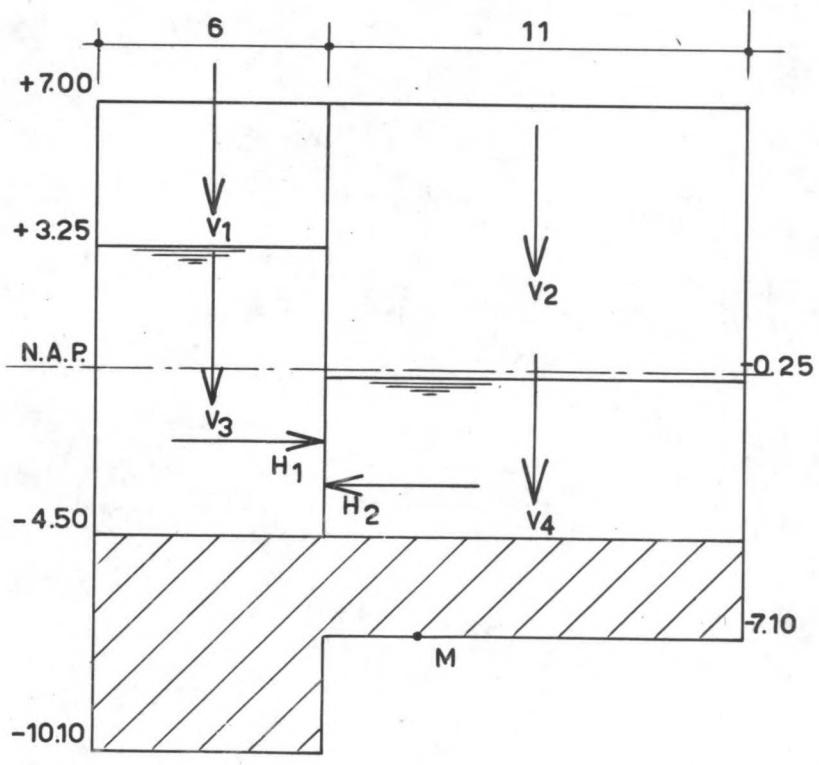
SCHEMA BUITENHOOFD ZOUTWATERZIJDE
